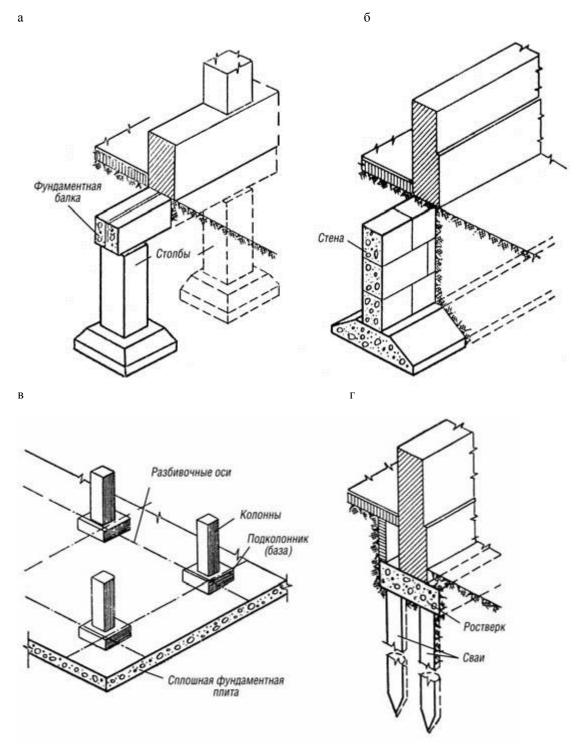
Фундаменты а) столбчатый, б) ленточный, в) сплошной, г) свайный
